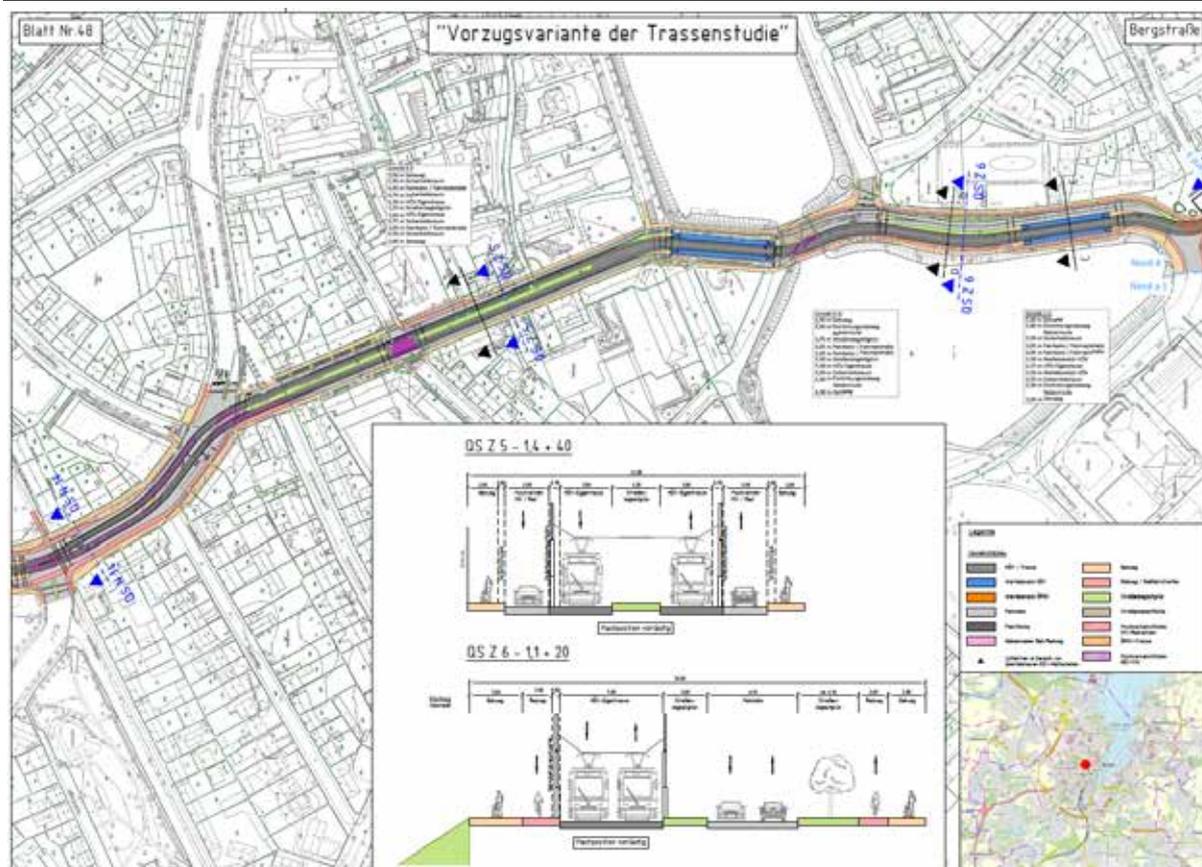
Beispiellageplan Dreiecksplatz - Bergstraße-Innenstadt, Maßstab 1:1.000
